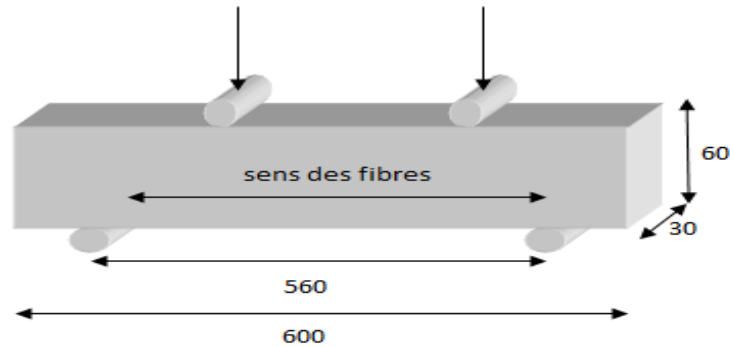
Dimension de l'éprouvette de flexion à 4 points.
